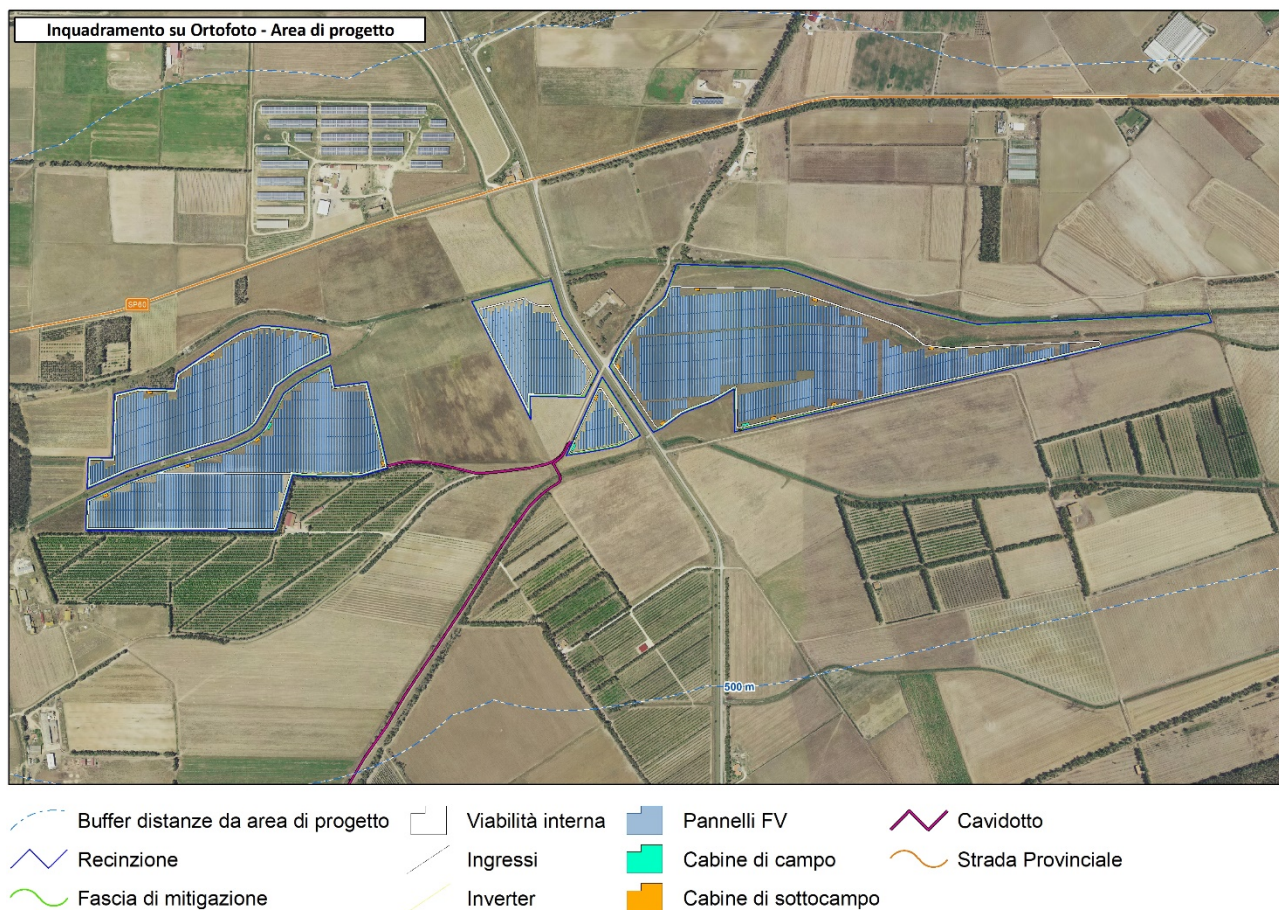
inquadramento su ortofoto- vista di dettaglio.
